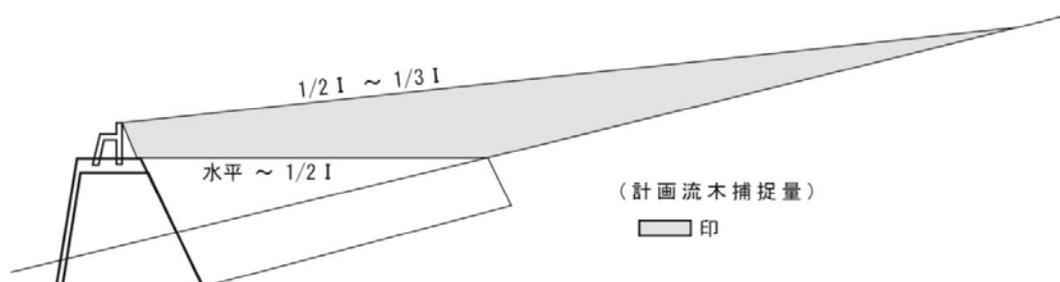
標準的な設置方法の場合の鋼製流木捕捉工による計画流木捕捉量の考え方
